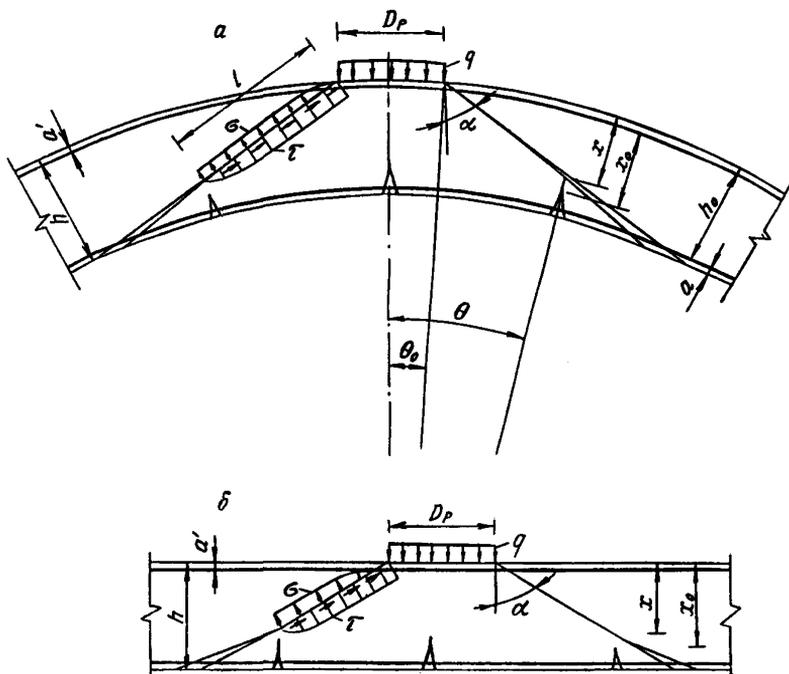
Расчетная схема конструкции: а — для оболочек; б — для плит
